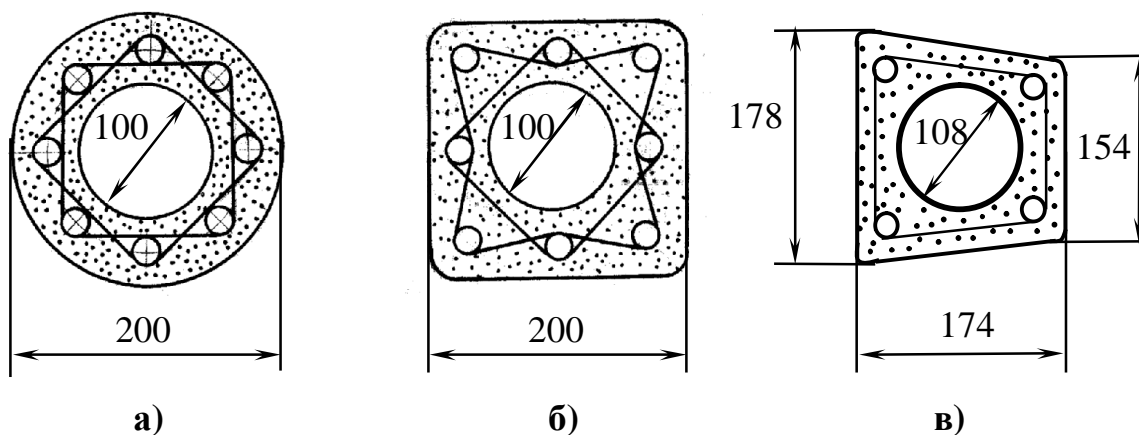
Разновидности железобетонных стоек по их поперечному сечению: а – круглые; б – прямоугольные; в – трапециевидные
